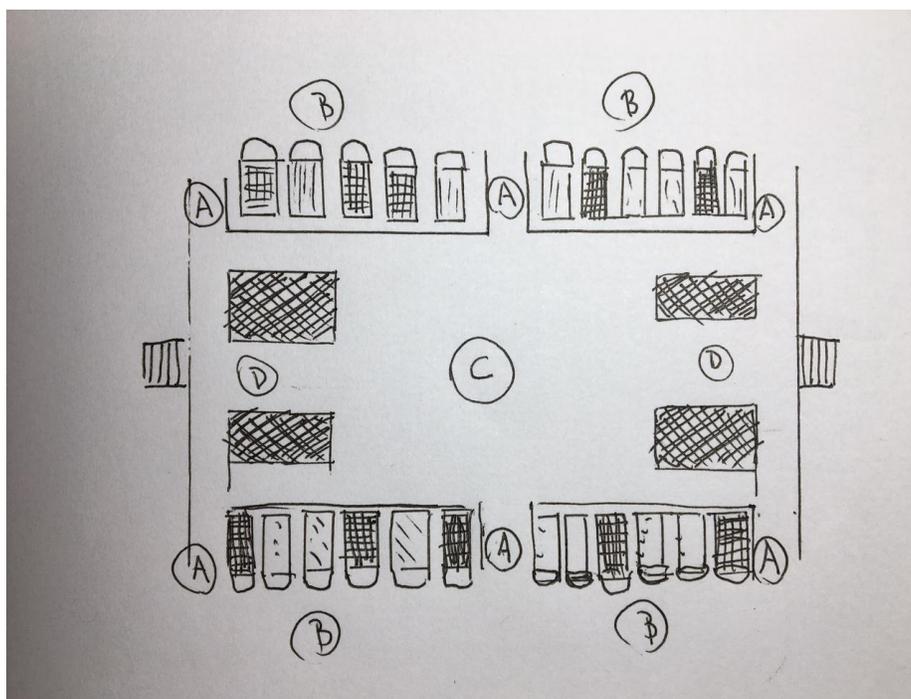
Esboço de planta baixa do Pavilhão 21 feita pela equipe na locação
